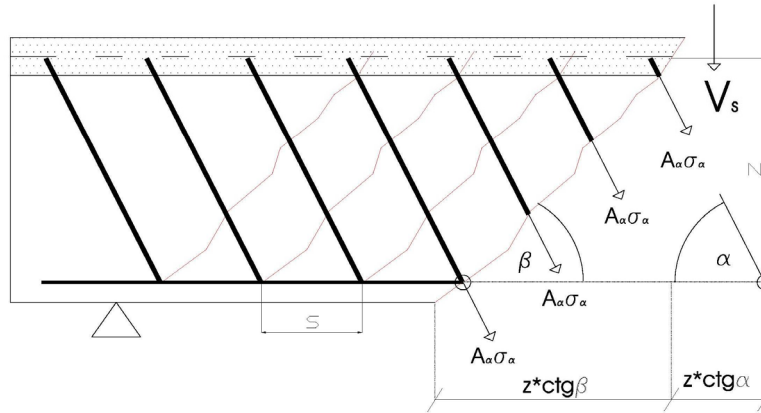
Equilibrio de esfuerzos aportado por las armaduras transversales
